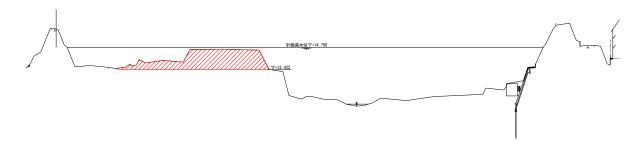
A-A断面図 (猪名川 7.2k 付近)
